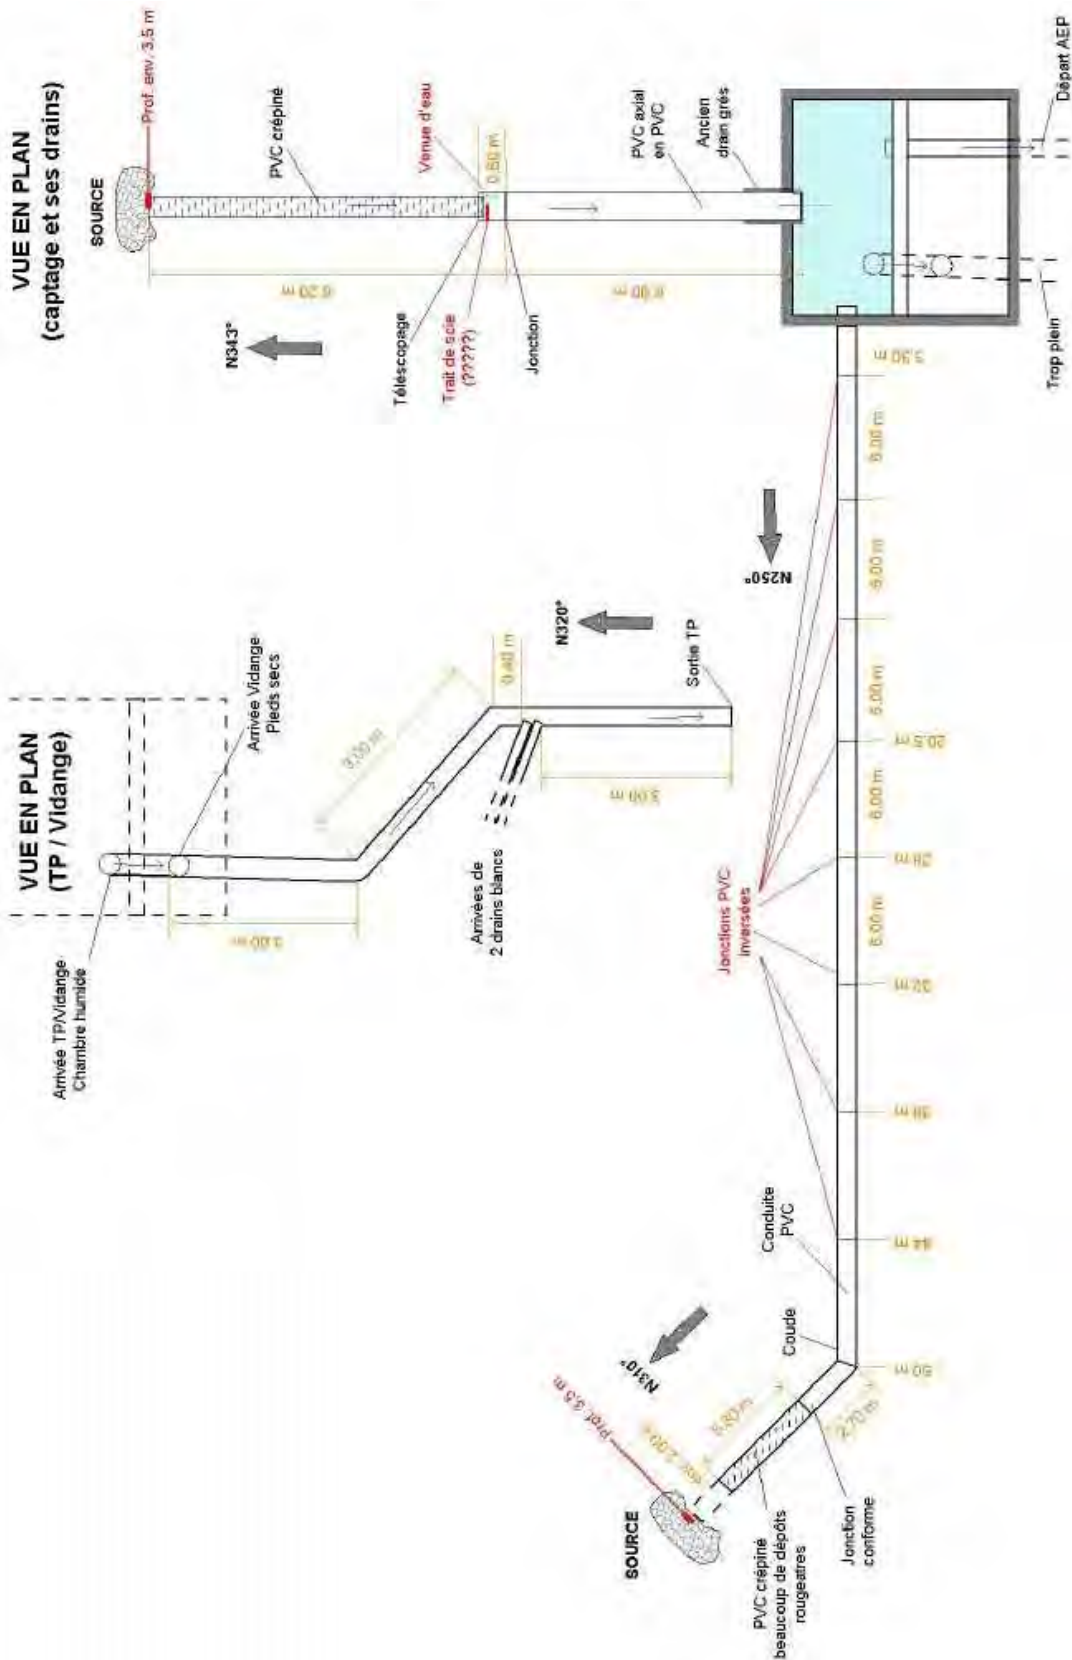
Coupe et plan drains et conduites Font des Rases (d'après CPGF septembre 2021)
